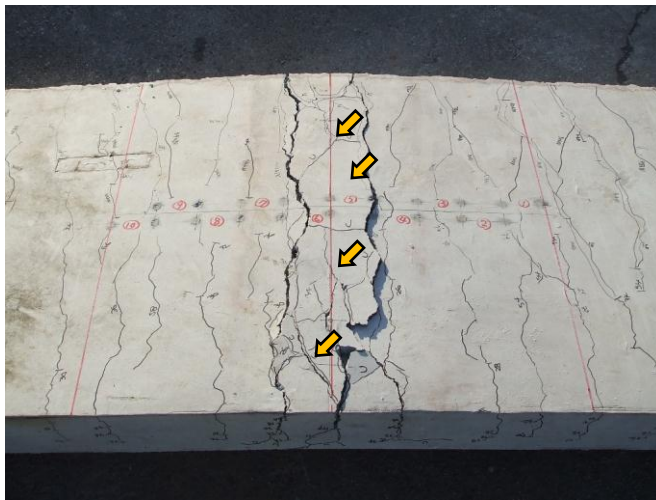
実験終了後のひび割れ性状 (C3 供試体)
